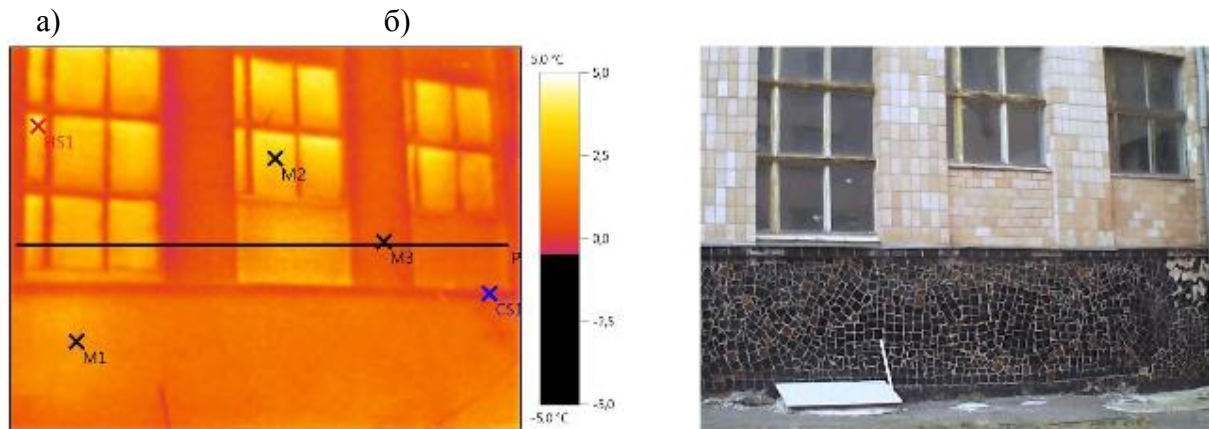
Фасад 1 – 10. Вікна лекційної аудиторії. Цоколь: а – зйомка тепловізором; б – фрагмент фасаду.
